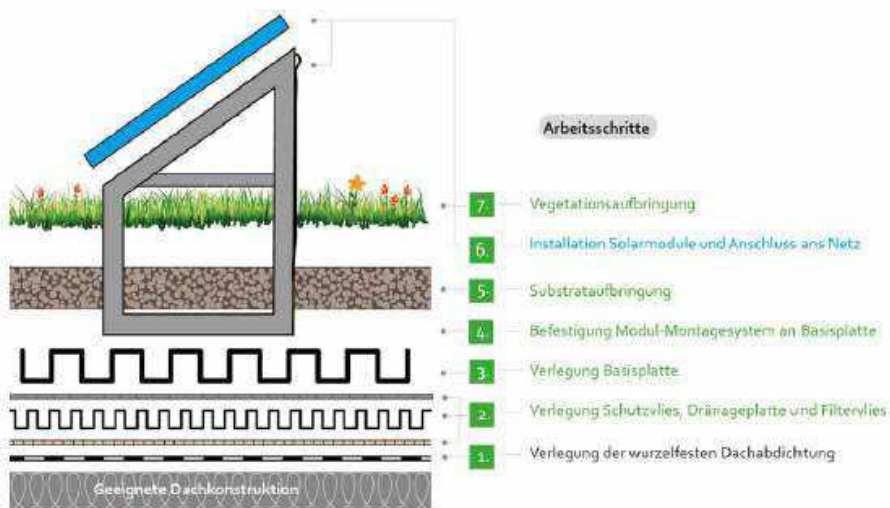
Dachaufbau eines Solar-Gründachs (Quelle: Bundesverband GebäudeGrün).
